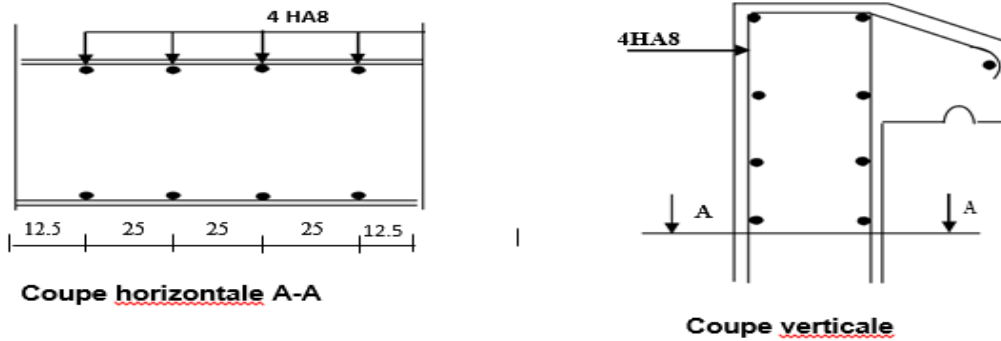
Schémas de ferrailage de l'acrotère.
